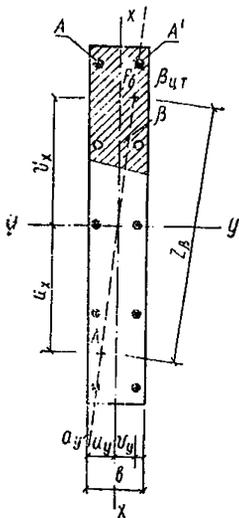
Поперечное сечение железобетонного элемента, работающего на косой изгиб
